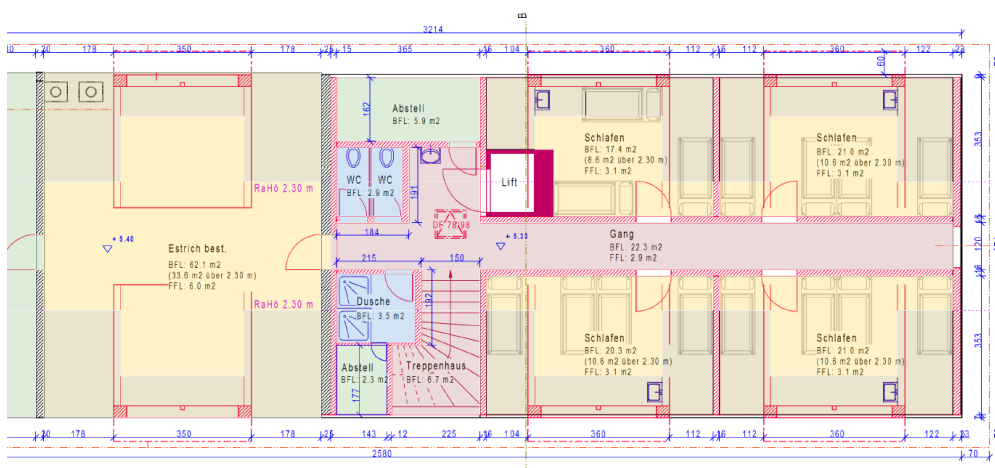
Ausschnitt Grundrissplan DG mit geplanten Dachgauben
